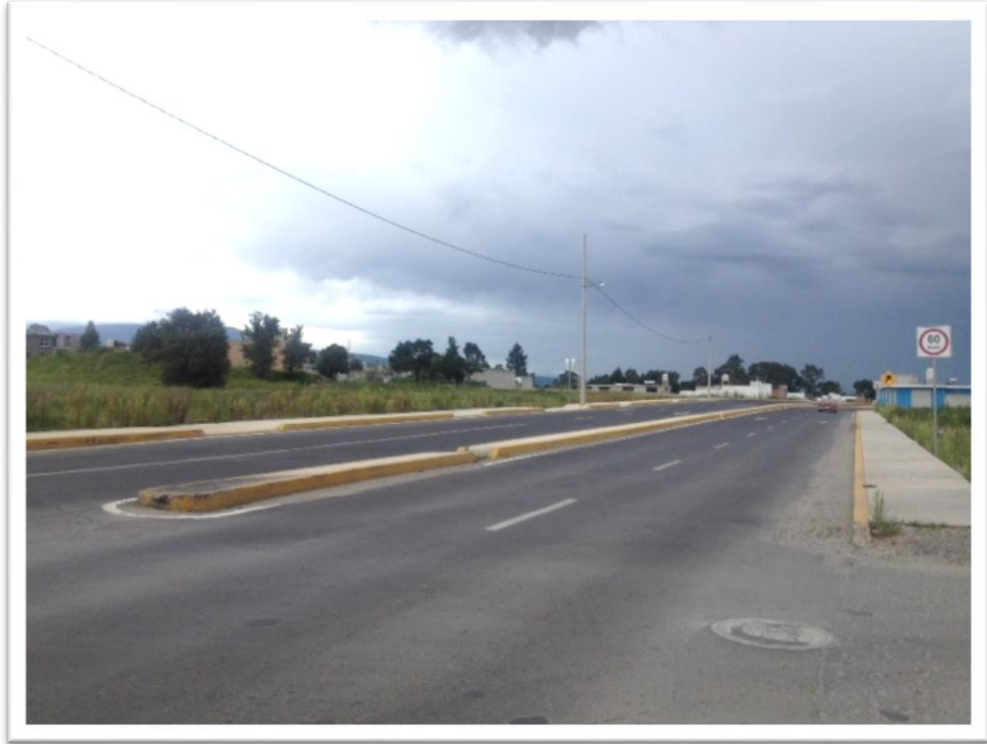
Vista lado sur de la calle Prolongación Avenida Cuauhtémoc.
